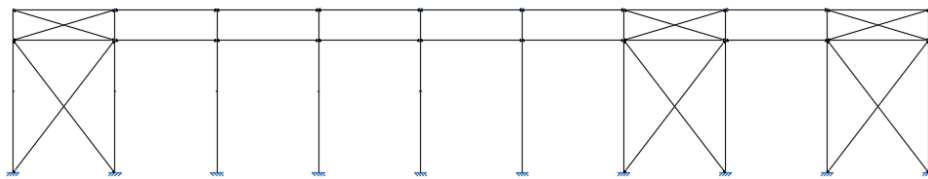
Fachada lateral de la nave de menor tamaño
